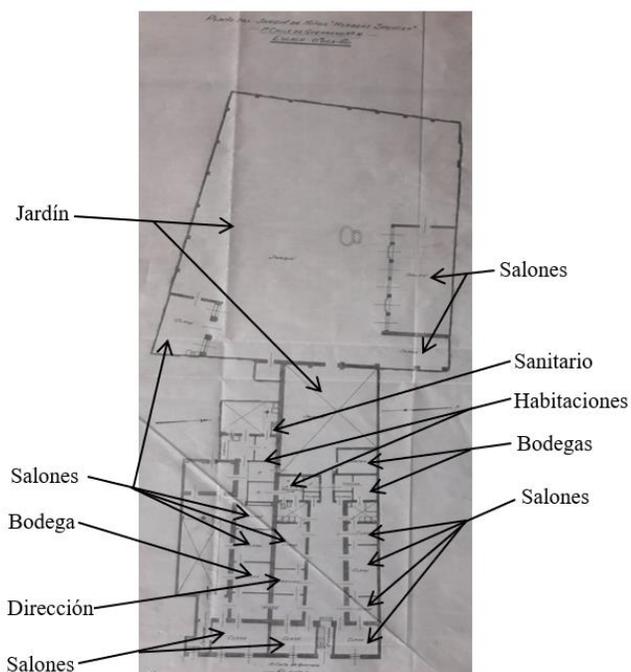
Plano del Jardín de Niños "Herbert Spencer" 1ª calle de Guerrero No. 16. AHCM, Planoteca, Módulo 4, Planero 1, Fajilla 113, Clasificación 415.6(073)76, no. de plano 686.
